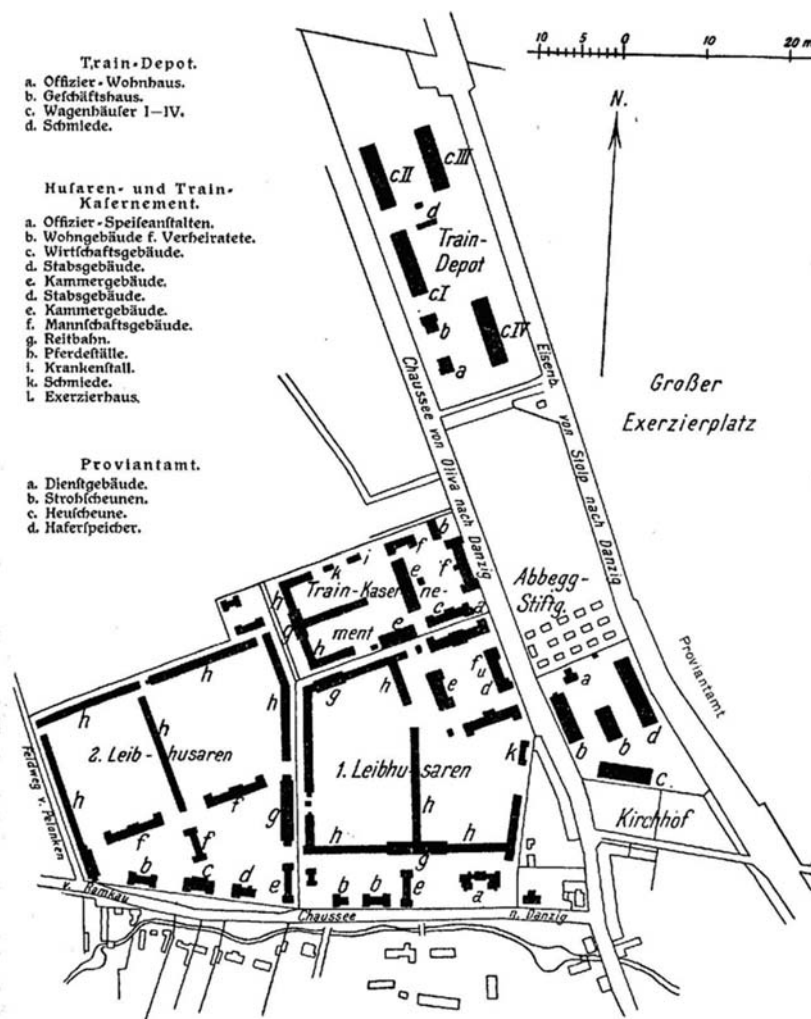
Lageplan der Garnisonanfallten in Langfuhr.
